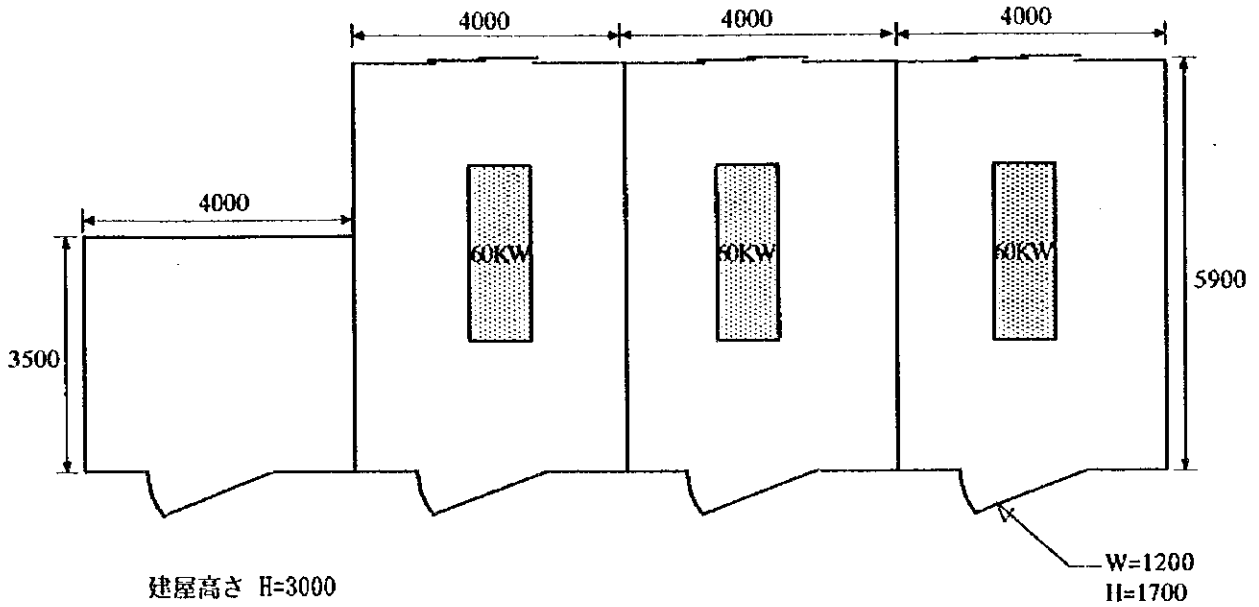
40 Tsagaan-Ovoo村の機器配置図
